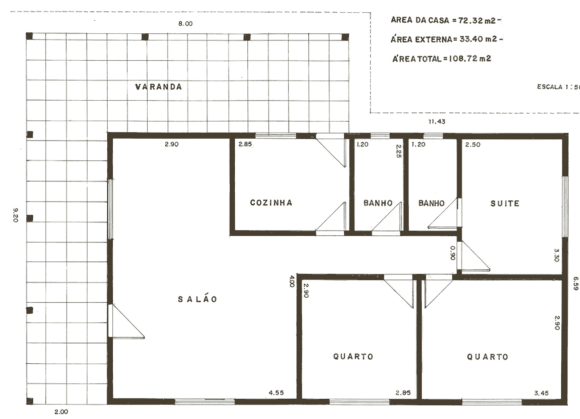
Planta baixa da maquete utilizada na demonstração. Fonte: autor.
